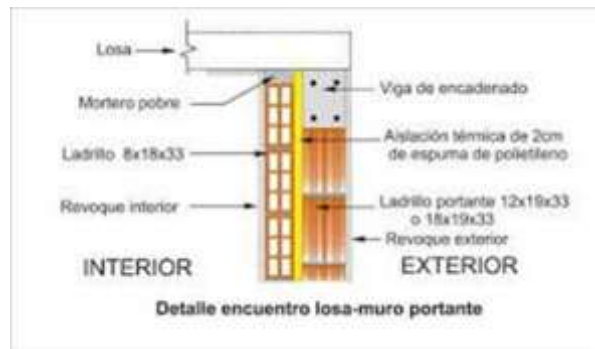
muro sándwich fuente: <https://www.murosandwich.com>
